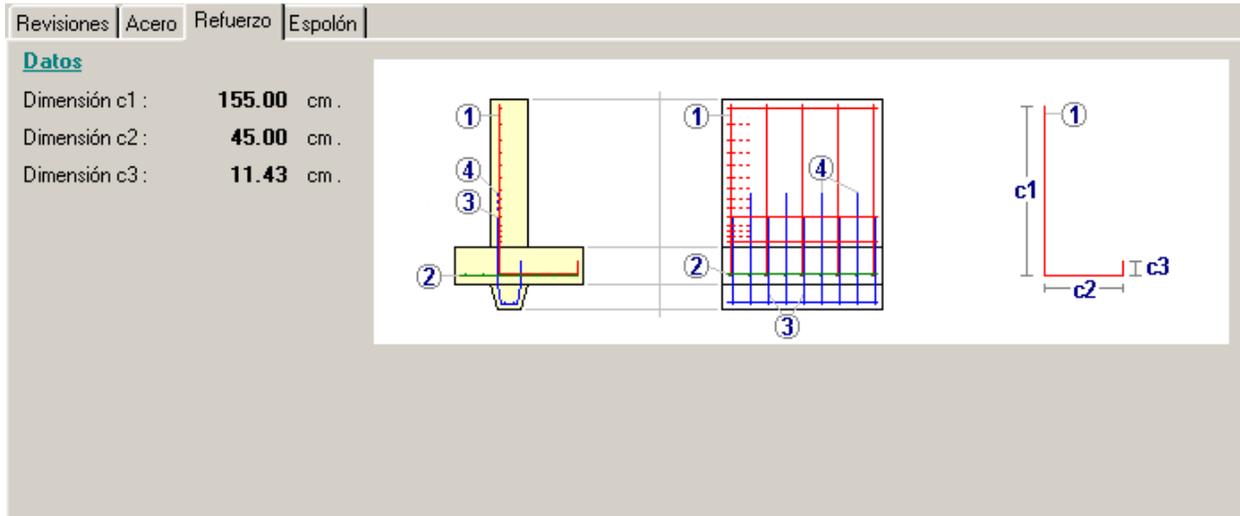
Cálculo de Muro Bajo en "T" sin sobrecarga.
